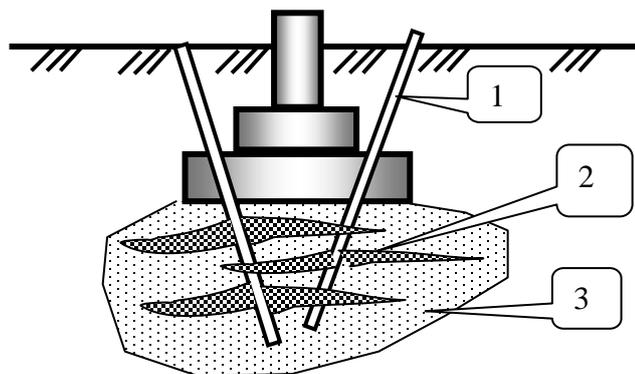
Принципиальная схема цементации (закрепления) основания под фундаментом реконструируемого сооружения с использованием «манжетной» технологии.
